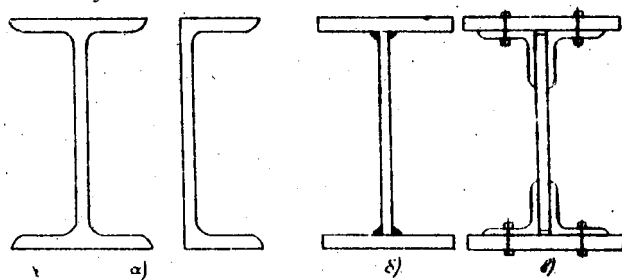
Типы балок: а) прокатные; б) составные сечения – сварные; в) клепаные.
